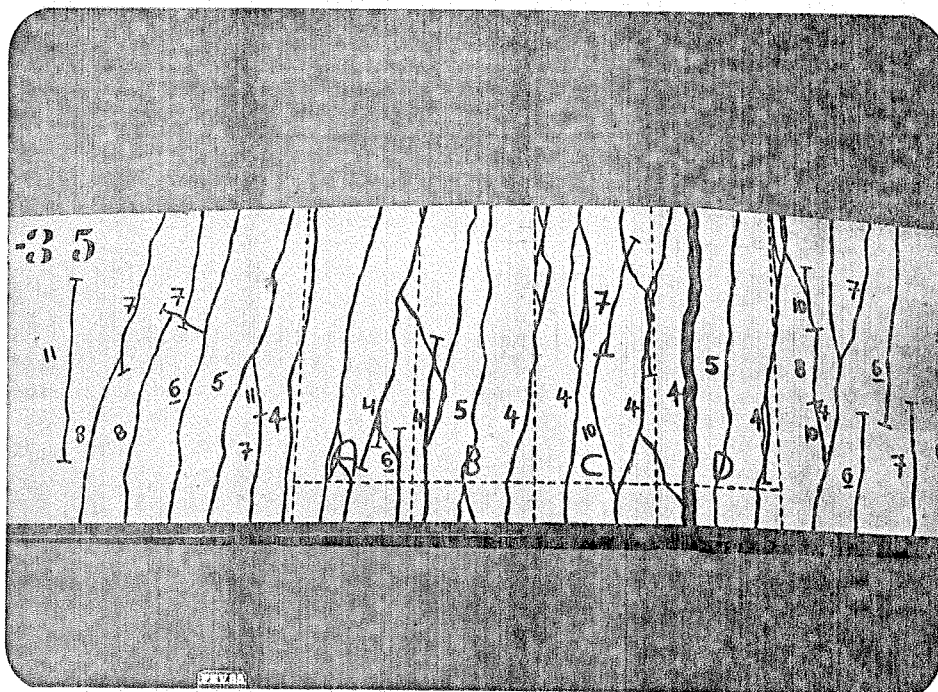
Detalhe da fissuração final - peça F111R35-3
